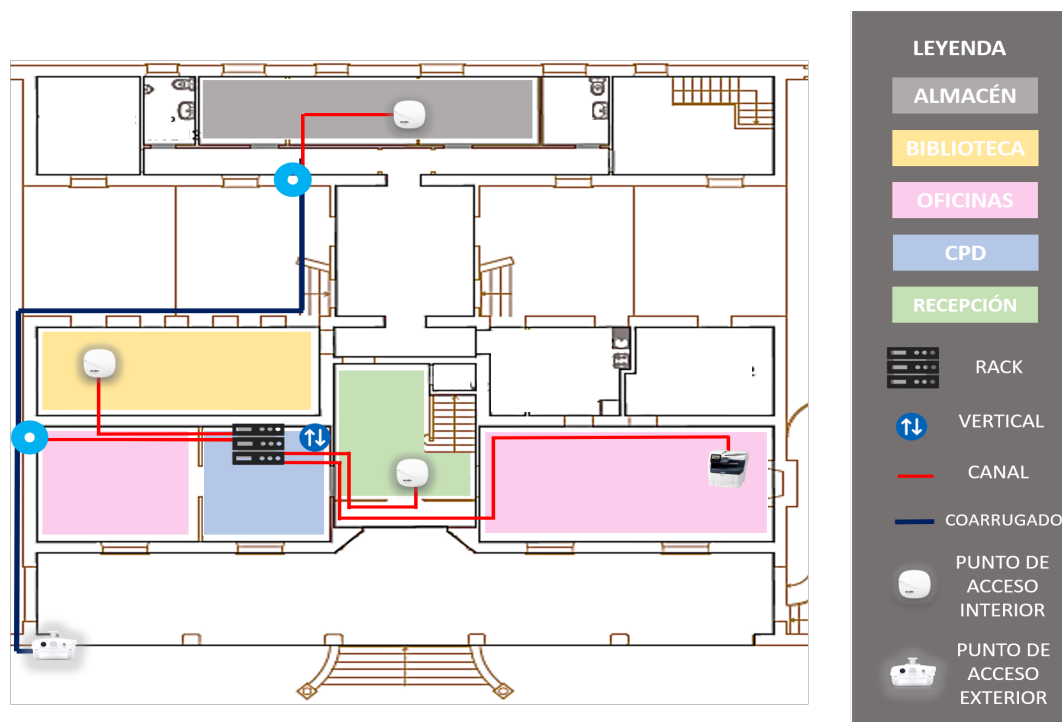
Cableado estructurado nuevo de la planta baja.
